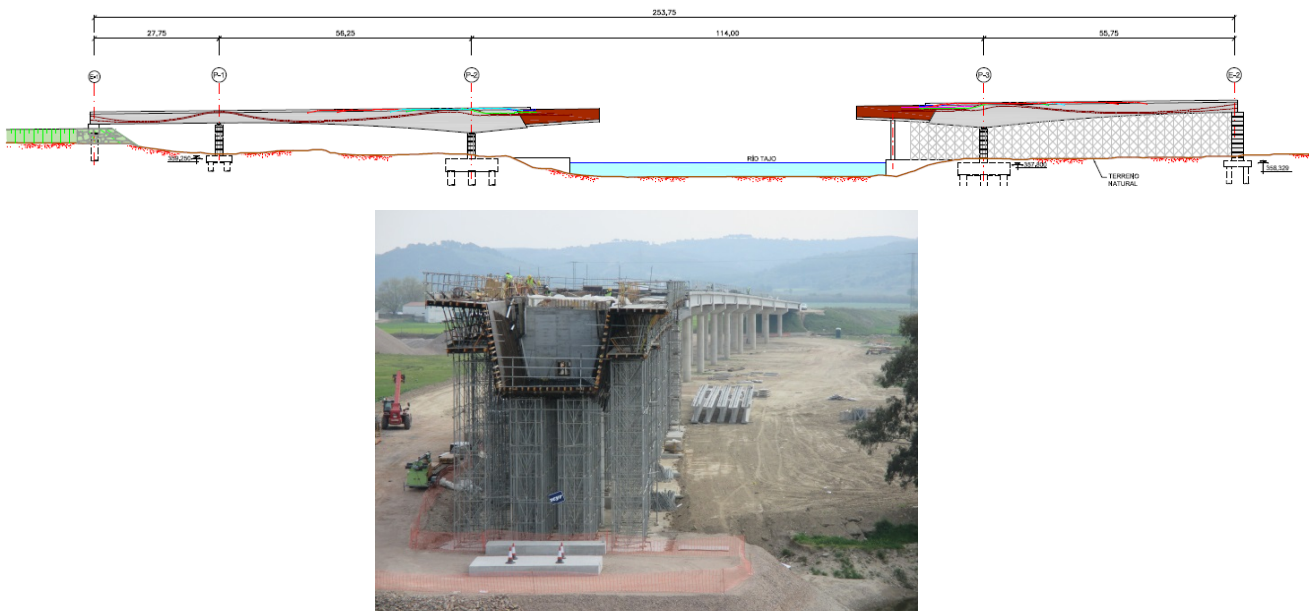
Montaje zona de cajón pretensado sobre cimbra
